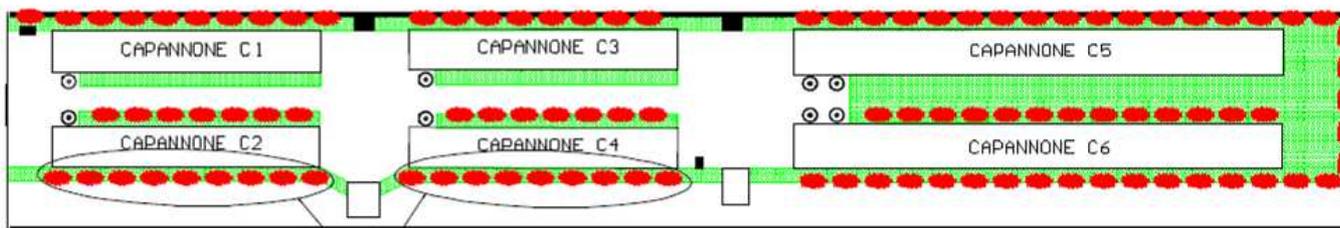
piantumazione dell'allevamento in rosso (fonte: A. I. A.)
